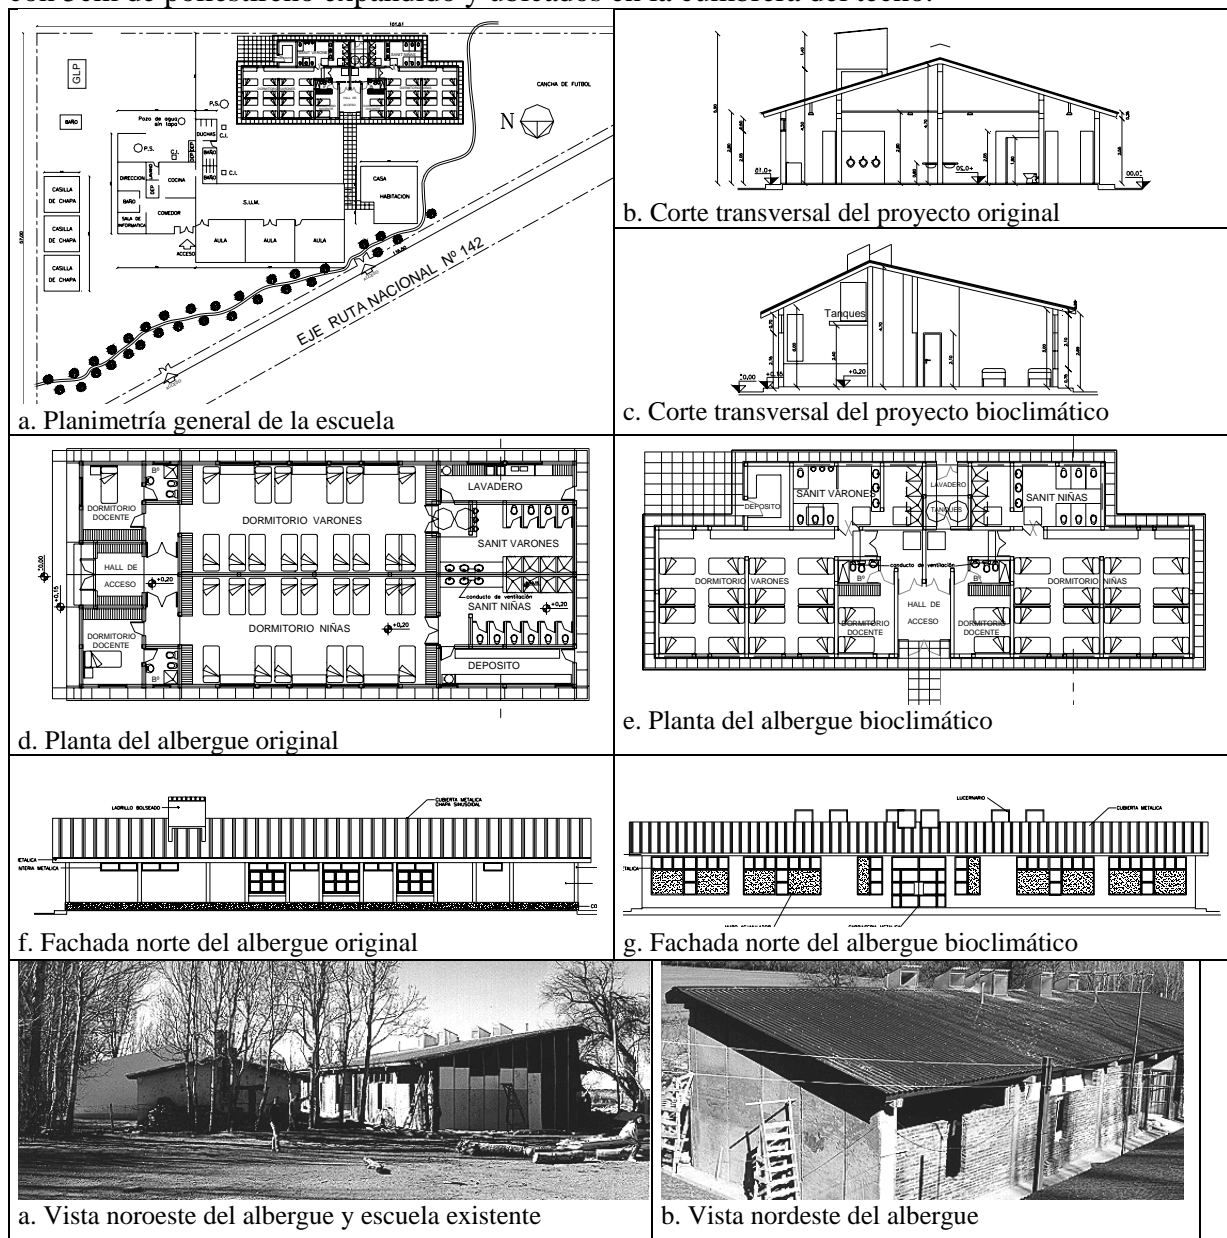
Planta, cortes y fachadas del edificio de albergue original y el bioclimático
